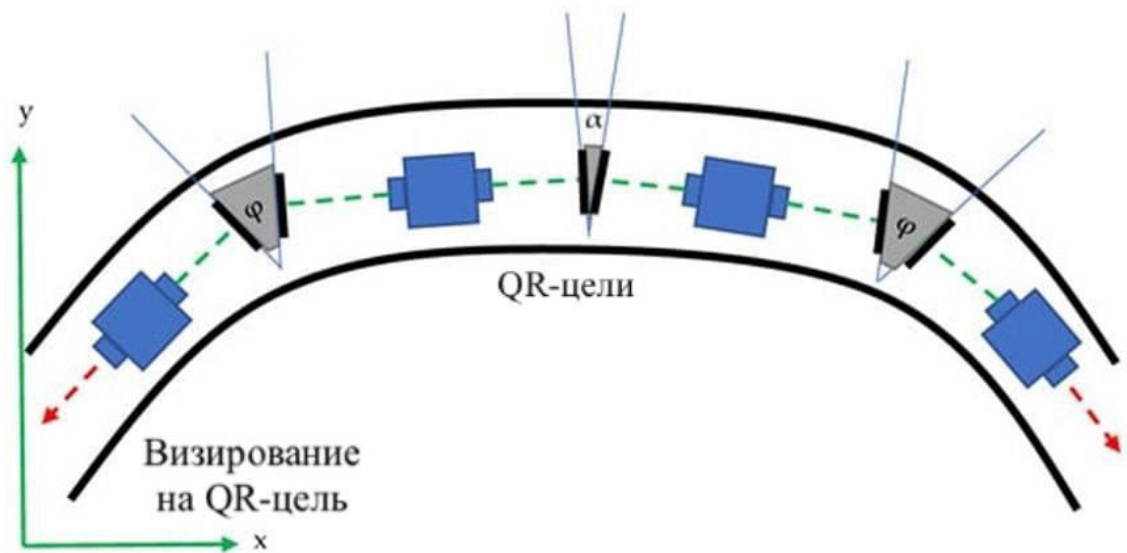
Схема установки СМЗ для криволинейной конструкции.
